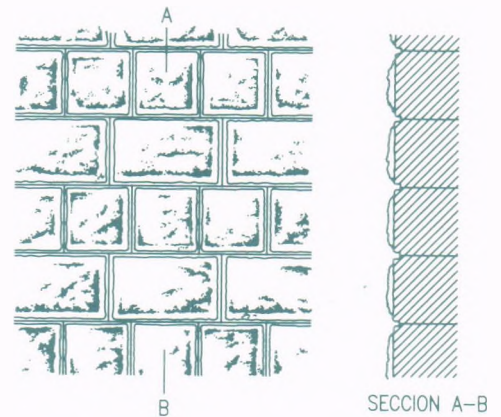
Alzado y sección de un aparejo de sillería almohadillada dispuesta a soga y tizón inglés, mostrando la protección de junta y tendeles, rebundidos respecto al plano exterior del paramento.
